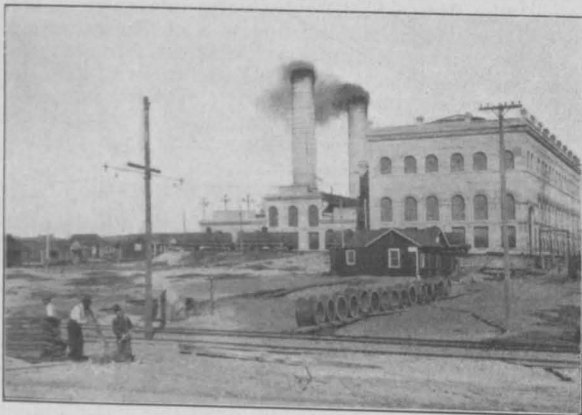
Fabrikbau in Eisenbeton in Los Angeles (Col.).
